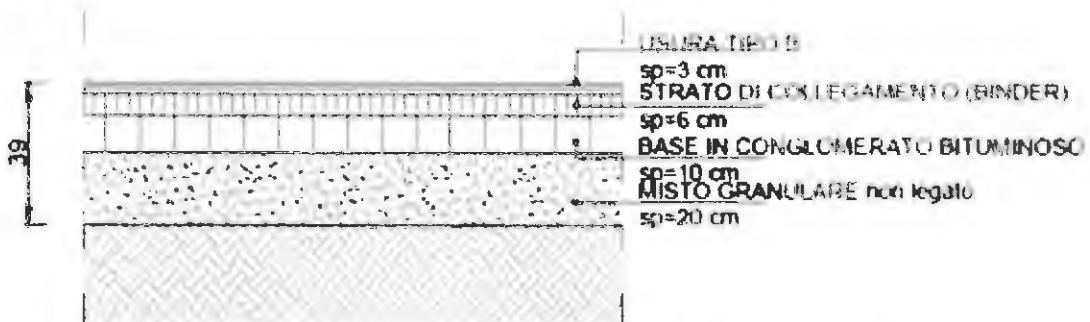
Sezione TIPO 4 progetto esecutivo – Rotatoria Svincolo Sud e Strada Locale 2
